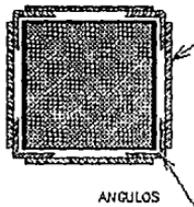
Apuntalamiento con ángulos y soleras de acero.
